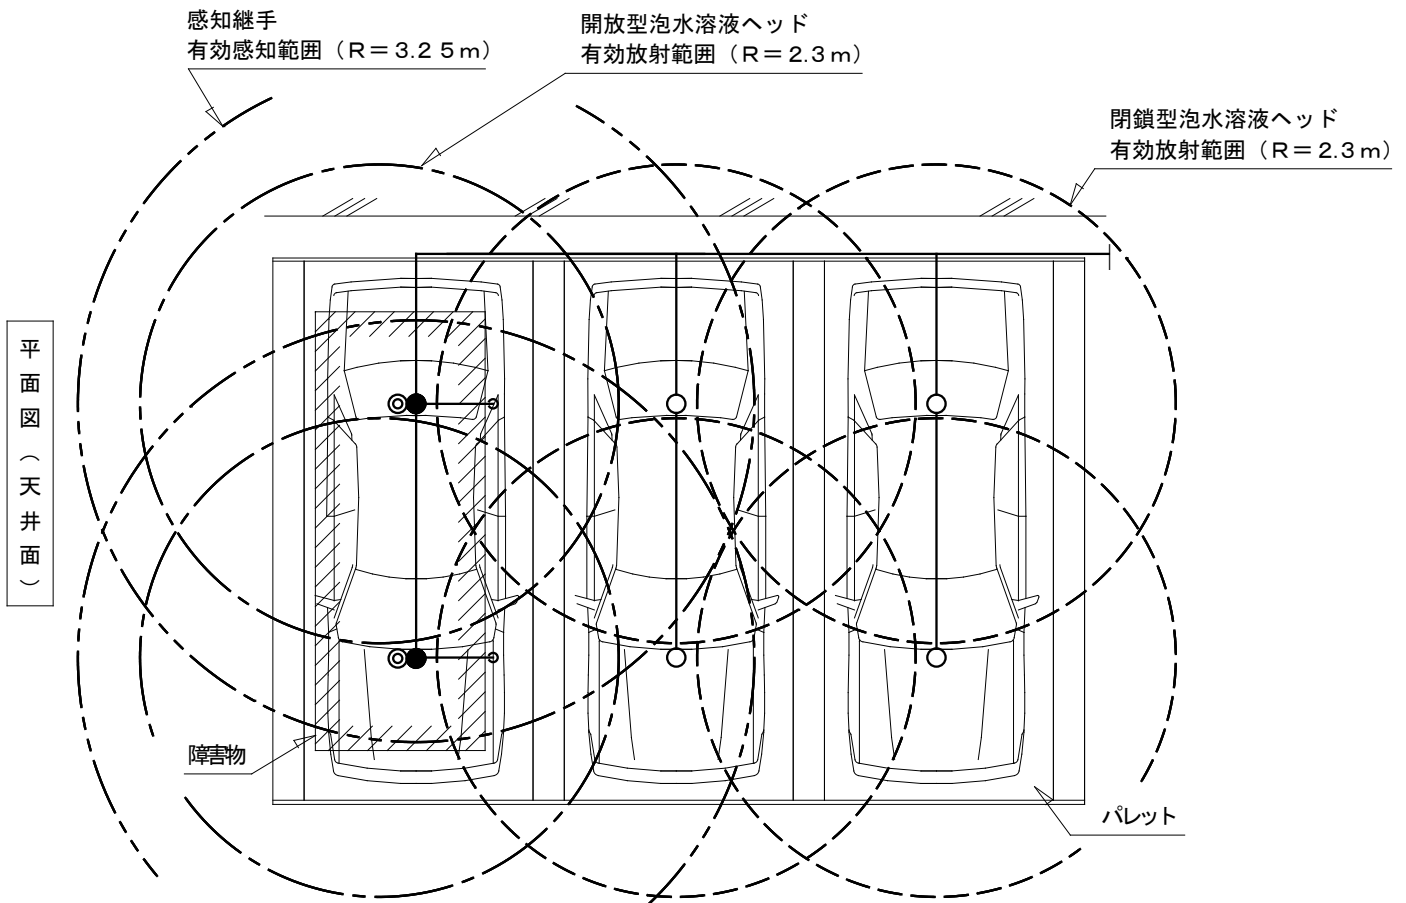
機械式駐車場設置例 (その 2)、平面図 (天井面)
